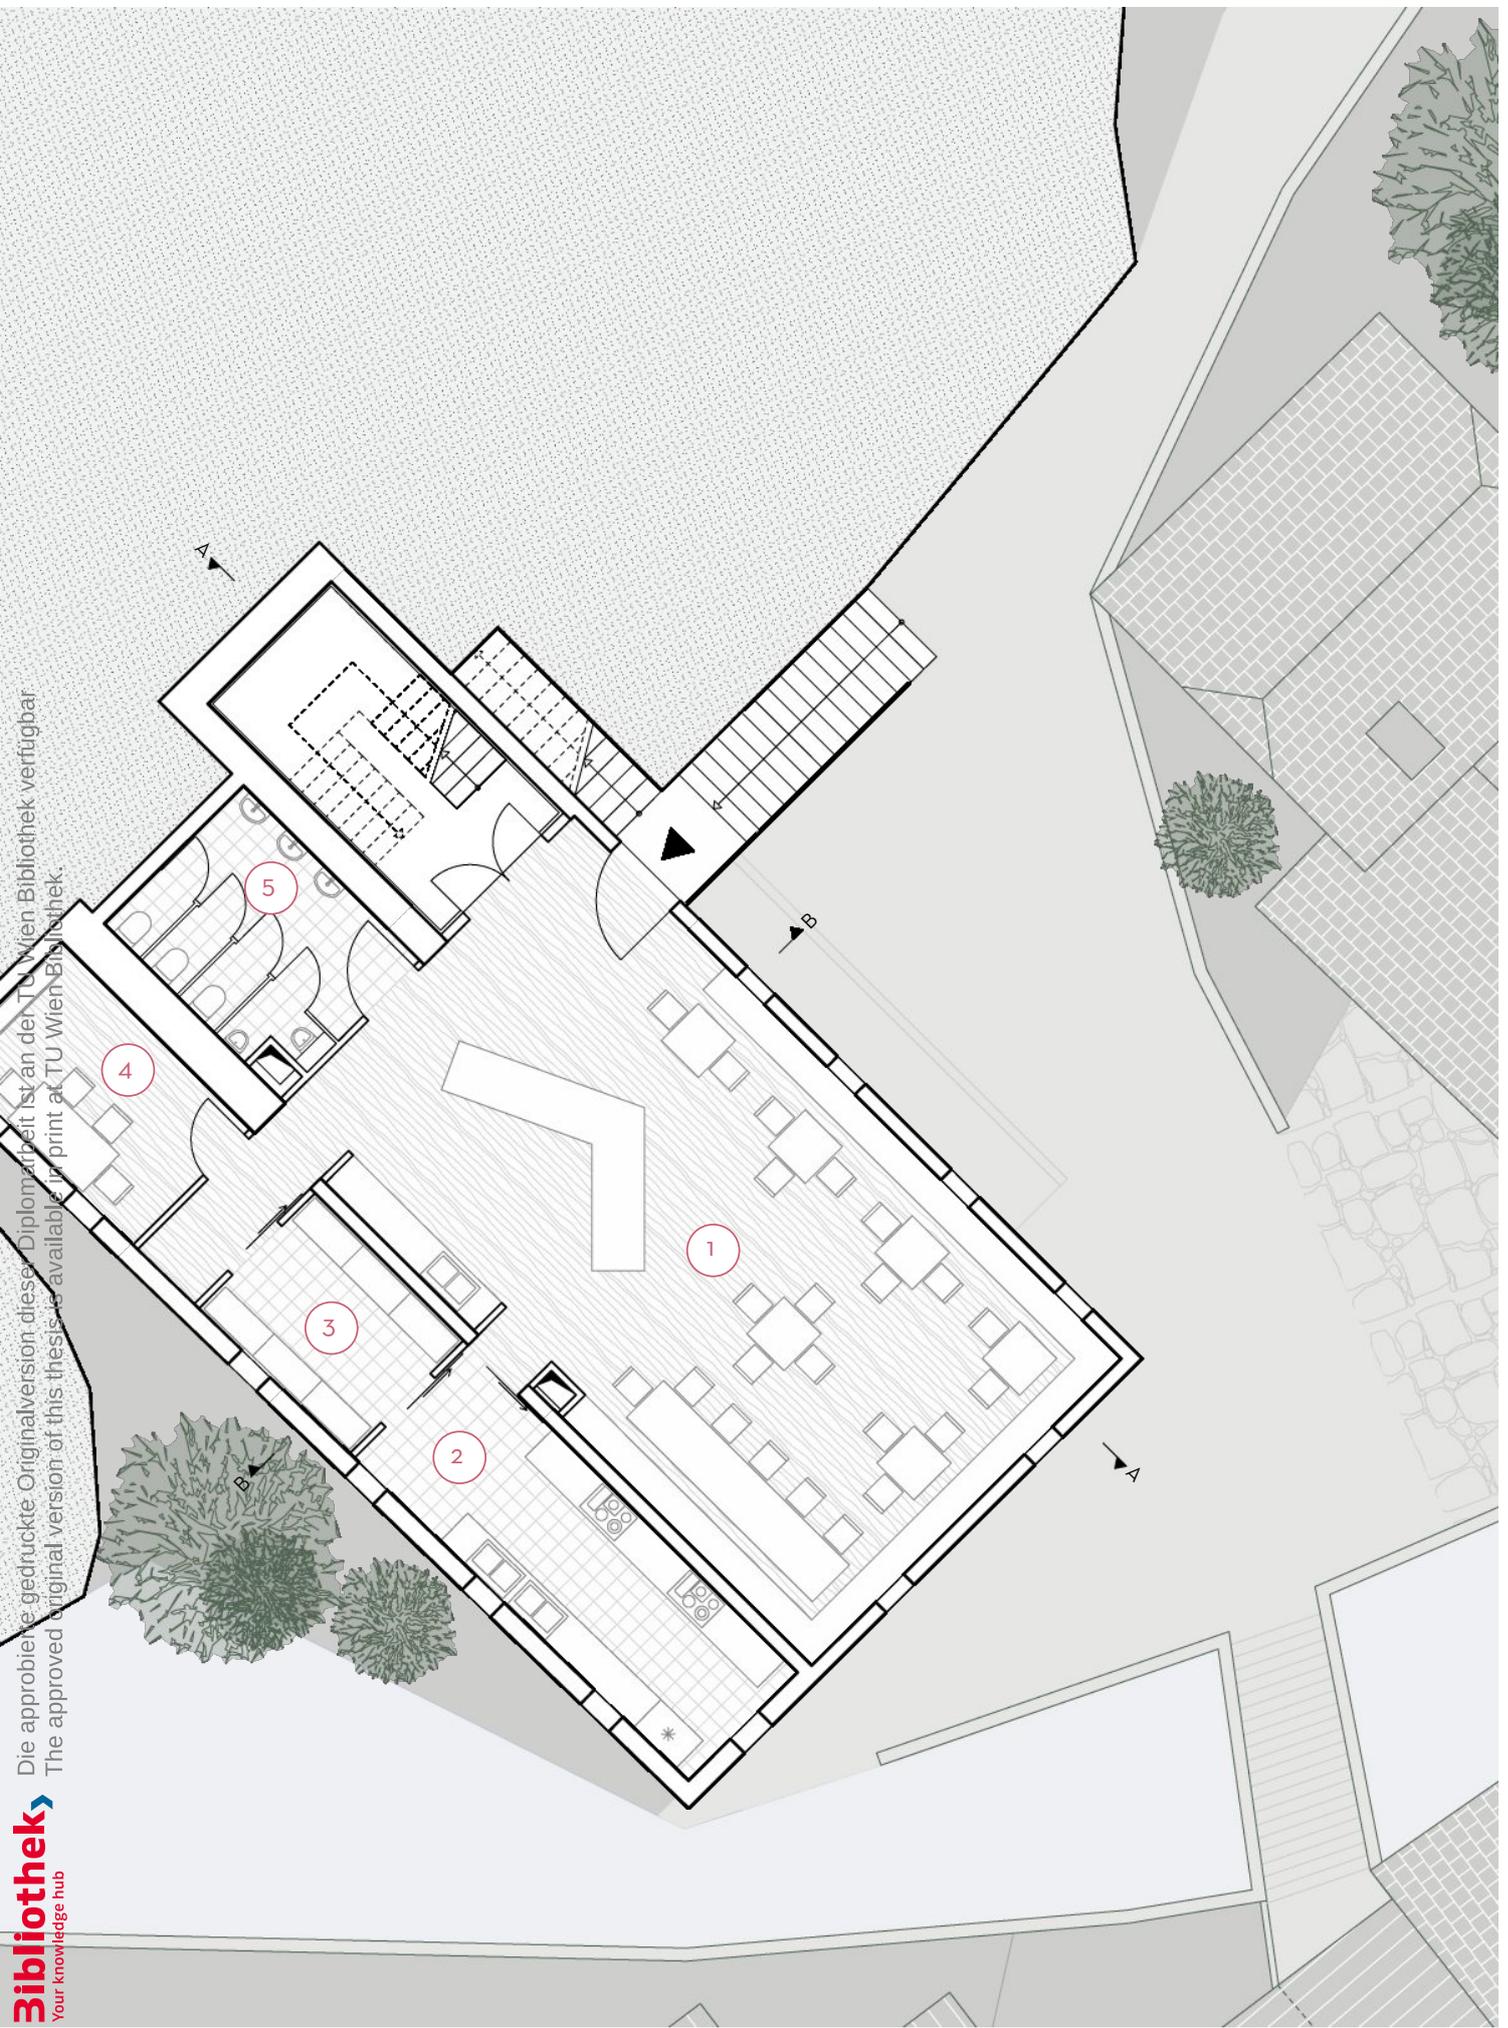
Grundriss Erdgeschoss nach Umbau
